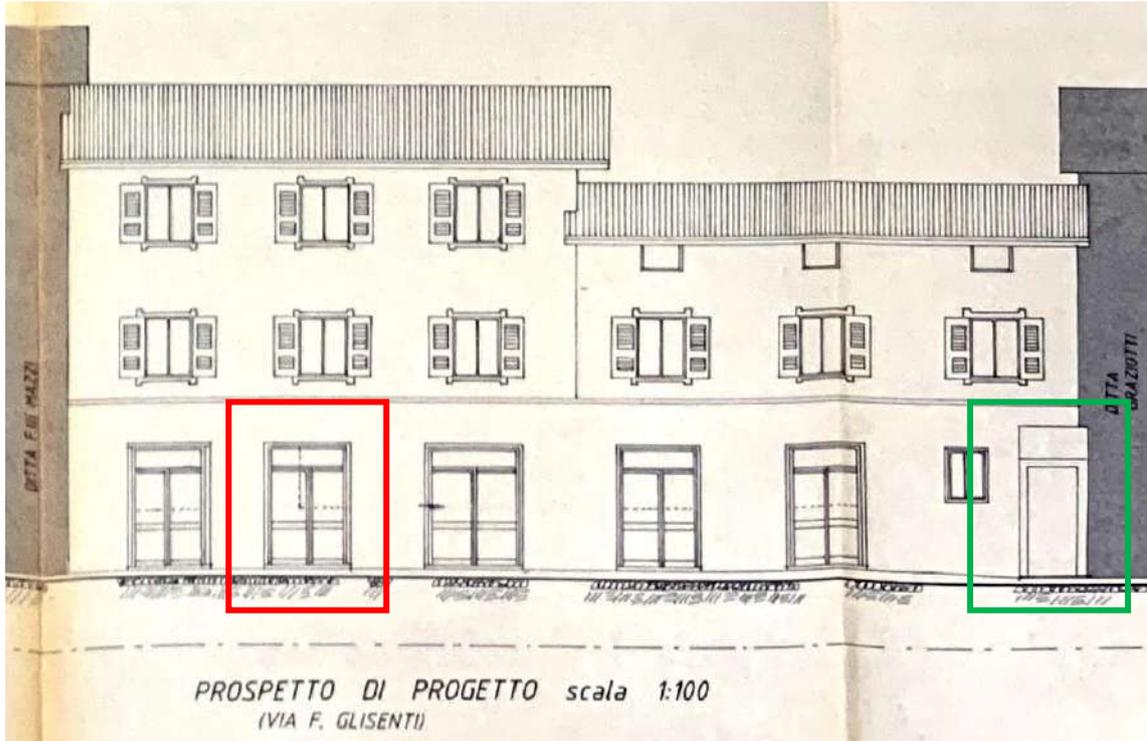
Concessione Edilizia n°18/93 – Prot. n. 1978, del 04/03/1993 estratto tavola di progetto con individuazione in prospetto dell'immobile oggetto di perizia (rosso) e dell'ingresso al corridoio comune (verde)
